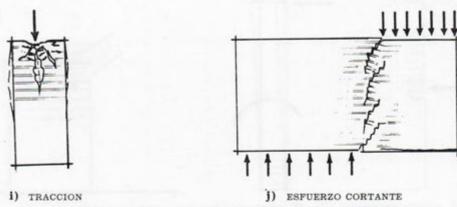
FISURAS EN LOS MUROS DE OBRA DE FABRICA
